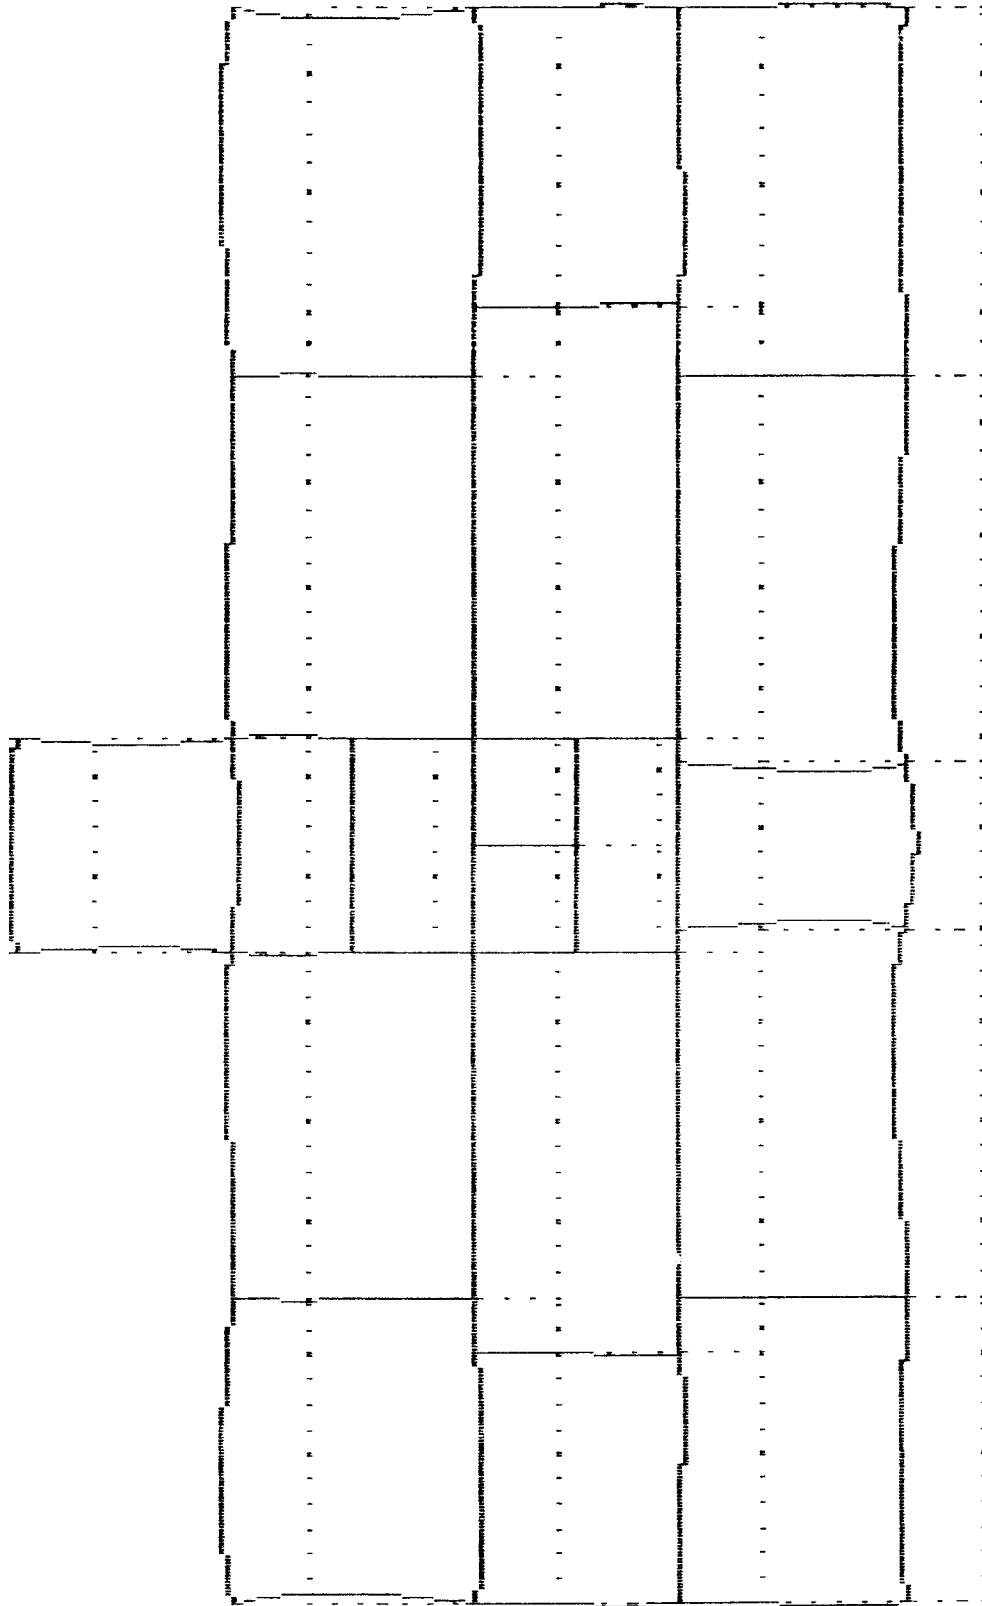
Vista em planta da posição deformada do 18.º pavimento devido à ação de vento atuando segundo a direção Y
